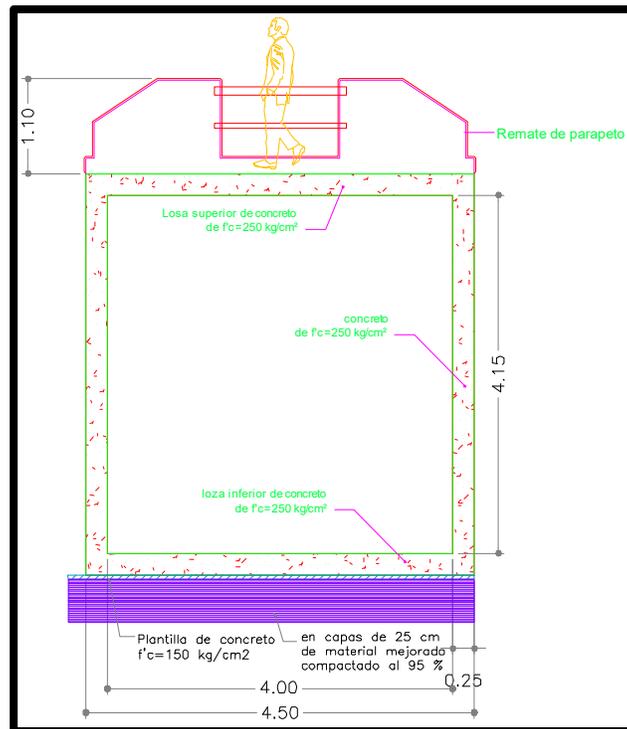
Sección transversal de las obras de cruce, puente de acceso y puente de salida del predio
